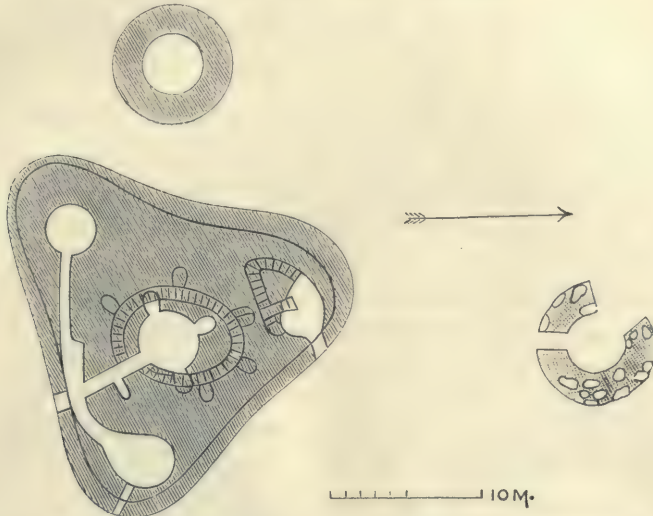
Grundriss eines grossen und zweier kleinen Nuraghen bei Losa, Sardinien.
